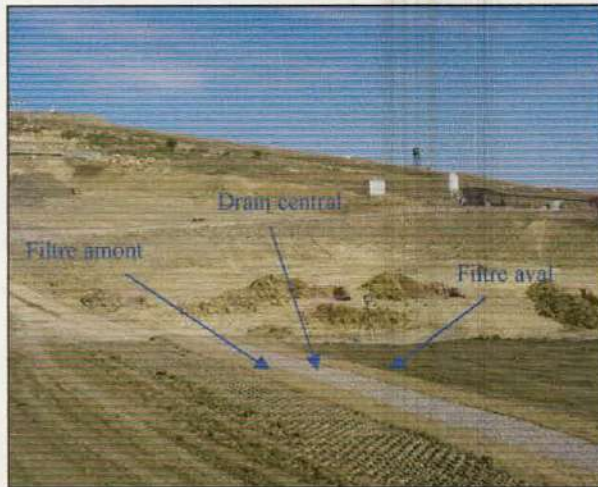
Dispositifs des filtres et du drain verticaux.
